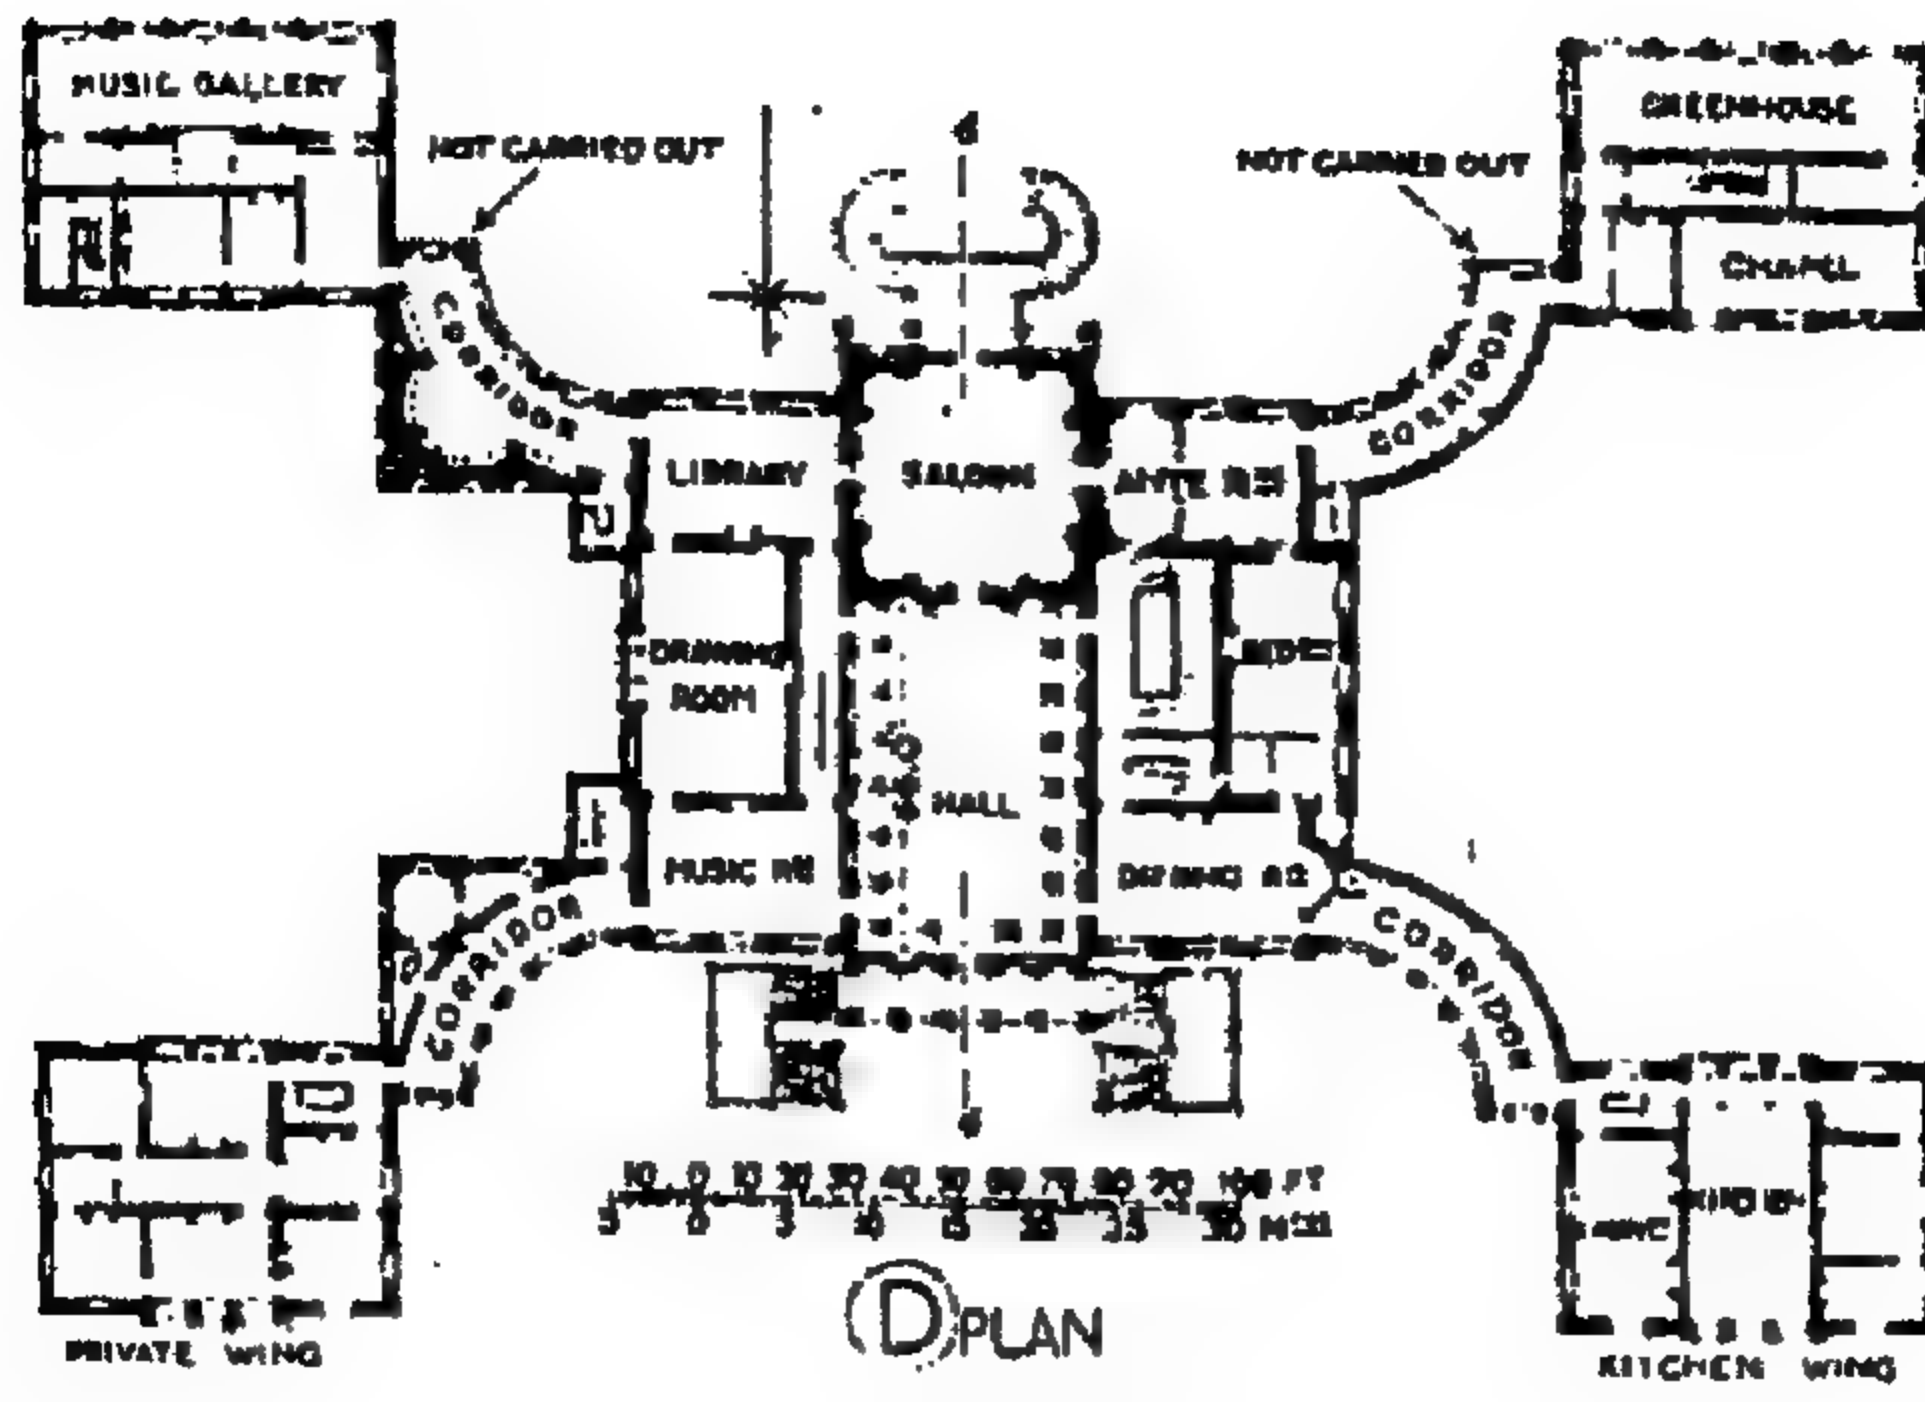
مسقط أفقي الدور الأرضي لقصر اسماعيل صديق المفتش
